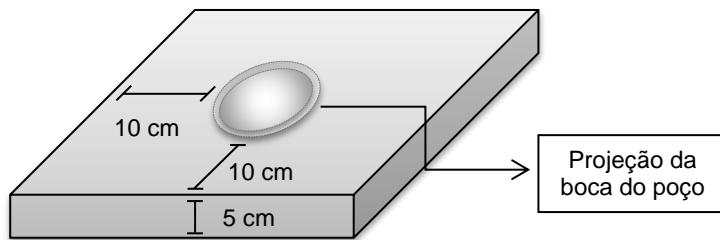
Desenho esquemático da laje de proteção sanitária do poço.
